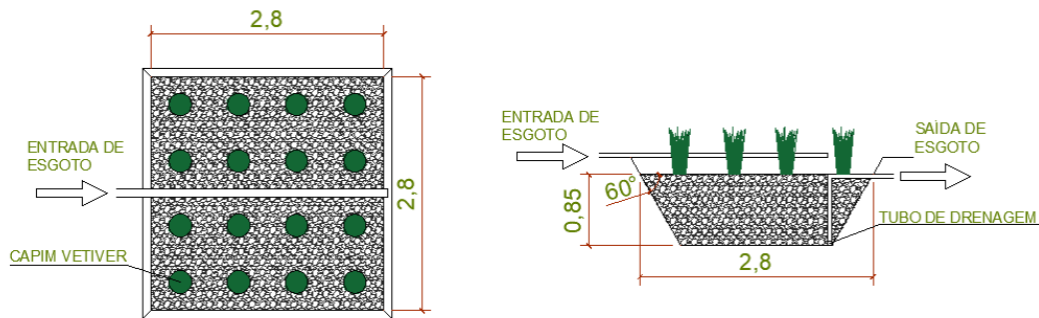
Planta baixa e perfil longitudinal do WC-FSSV.
